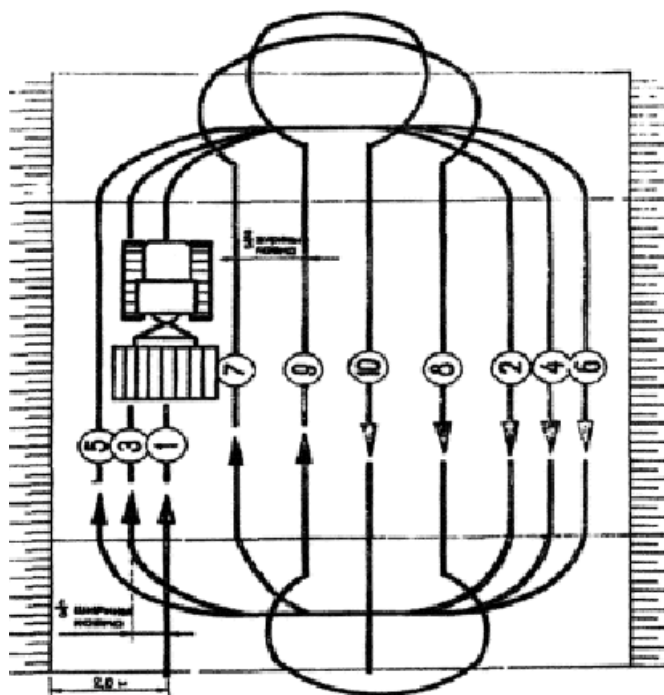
Схема уплотнения слоя насыпи земляного полотна
